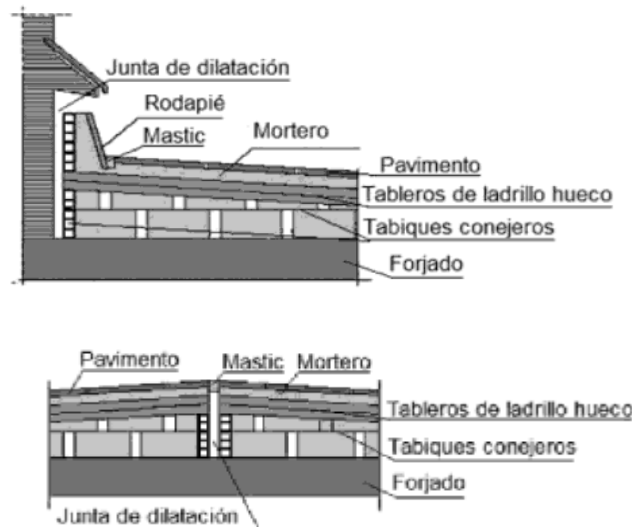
y 580.- Detalles de encuentro con antepecho y junta de dilatación en cubierta a la catalana. "Principios de construcción". J. Ferri. P. 285.
